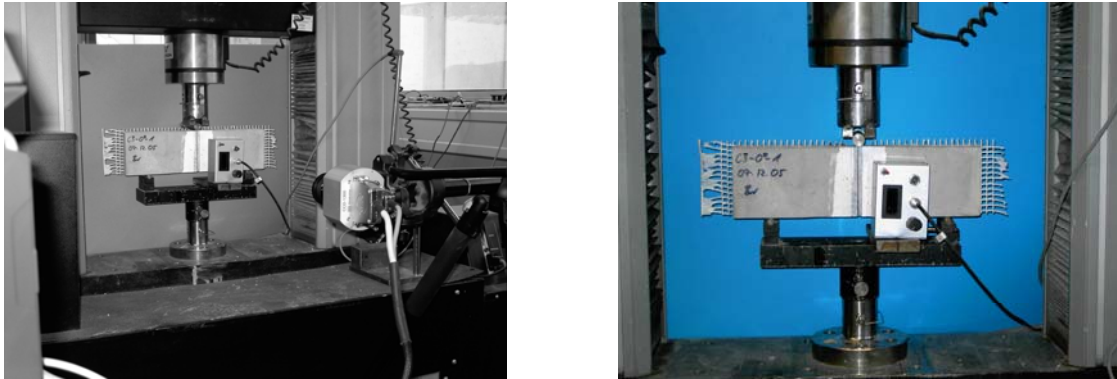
Versuchsaufbau mit Messtechnik Aramis (links), Ansicht (rechts)
